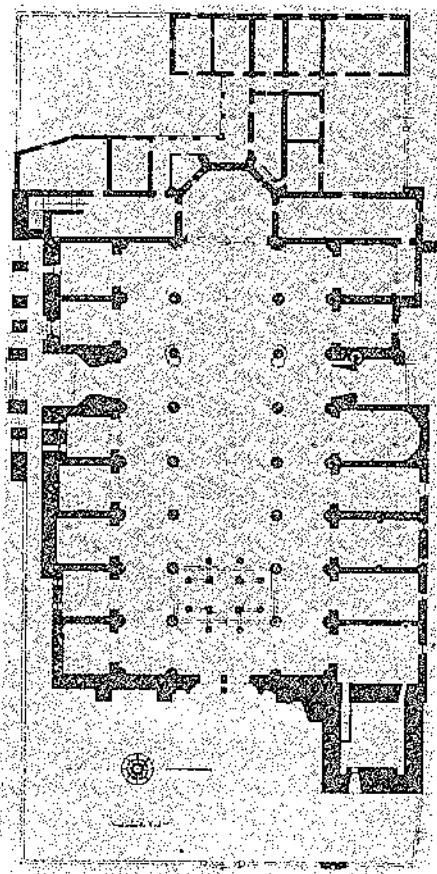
Planta de la catedral, según Buschiazzo y Utrera. SANTO DOMINGO.
